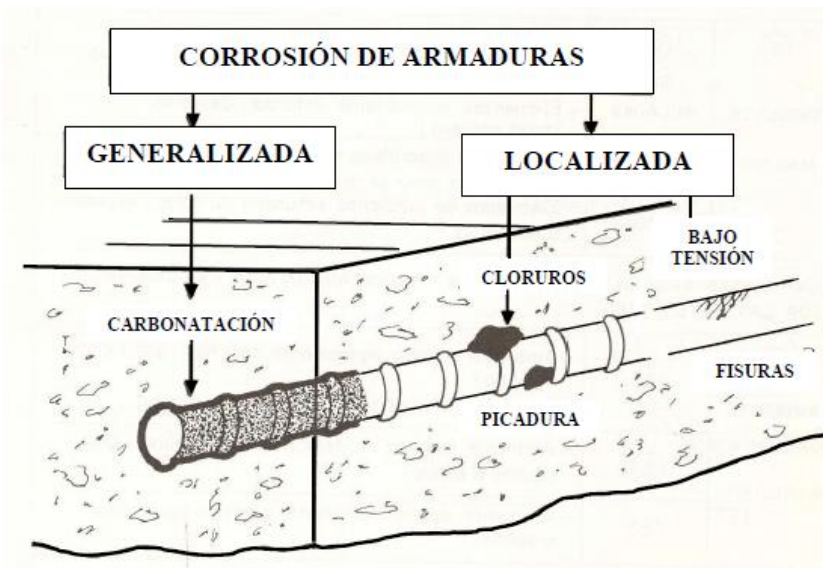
Tipos de corrosión ocurridas en el acero embebido en el concreto
